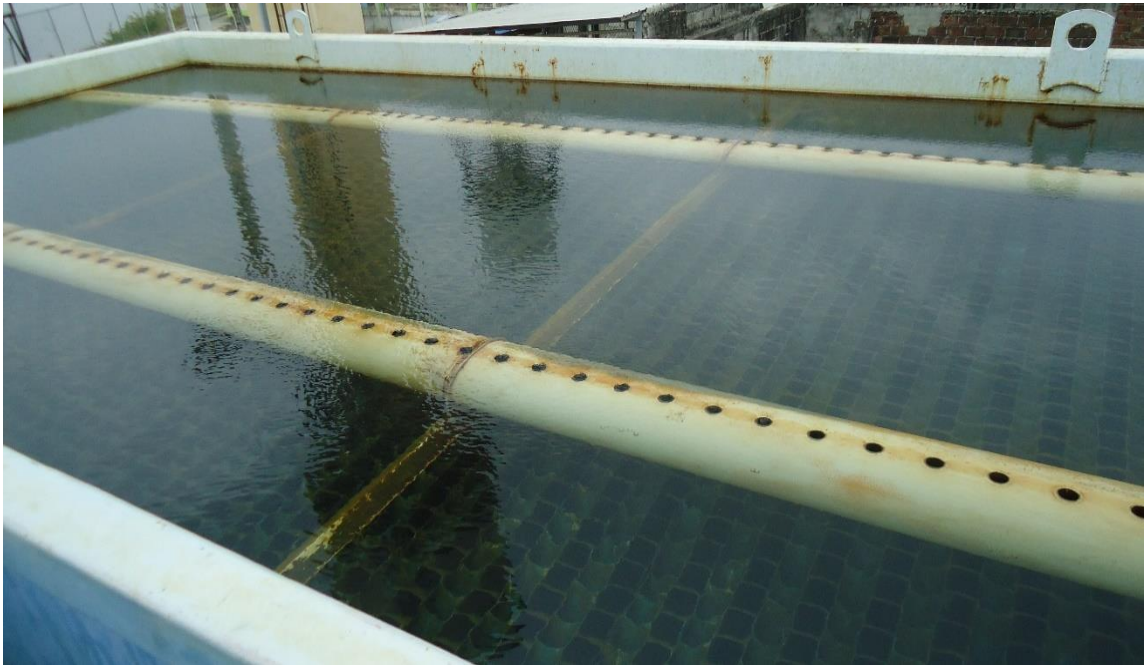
3 Módulo de sedimentación de la planta Intal, sector San Javier – Cantón Santa Lucía
